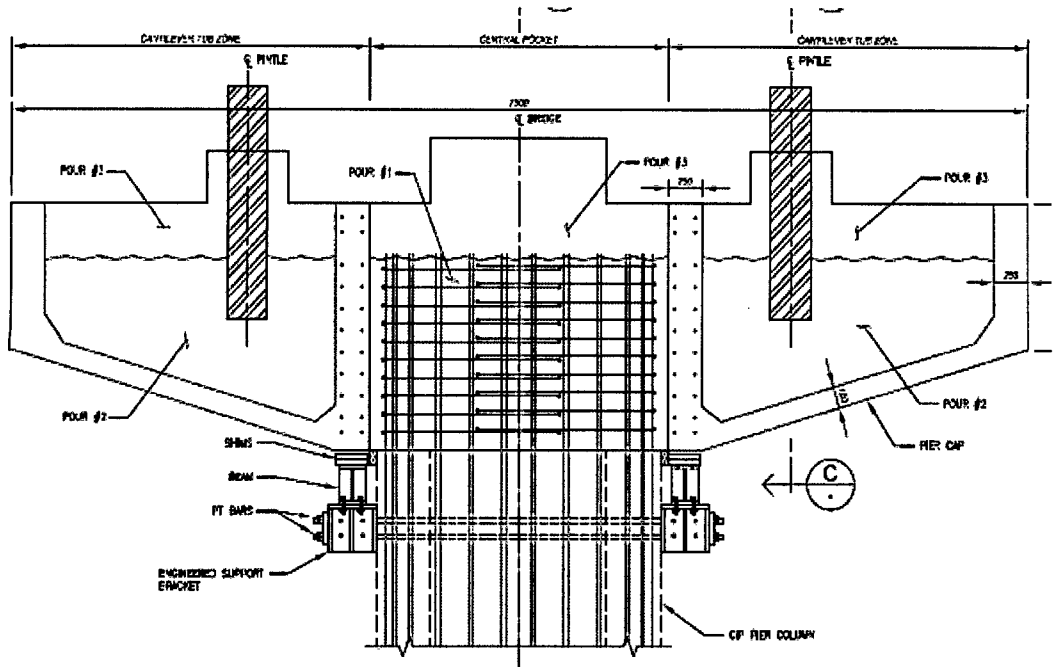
Planteamiento del Modelo N° 01 para fabricar vigas cabezales.
